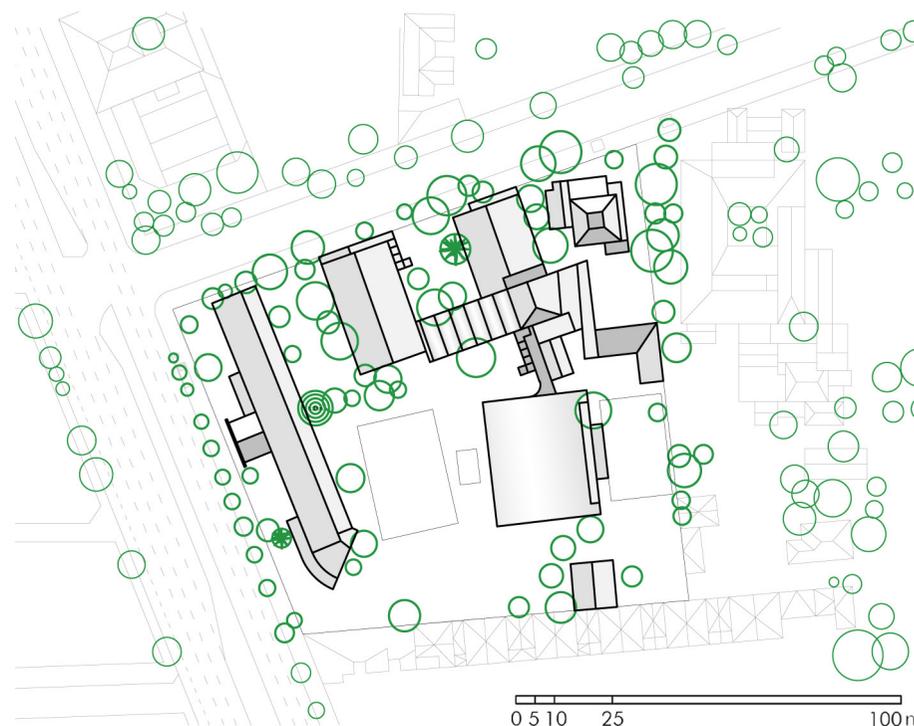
Levantamiento de vegetación preexistente, posición en planta. Elaboración propia, basado en Google Earth Pro (2020).
